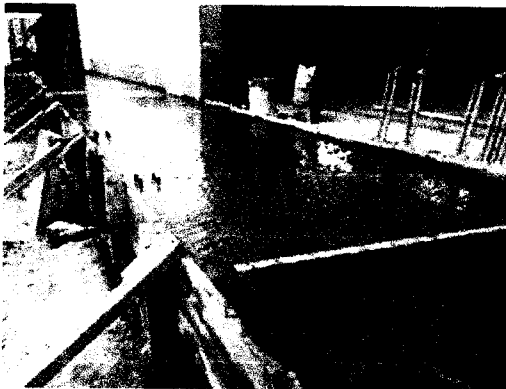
y 24: Levantamiento de muro de saga. PTAR.
